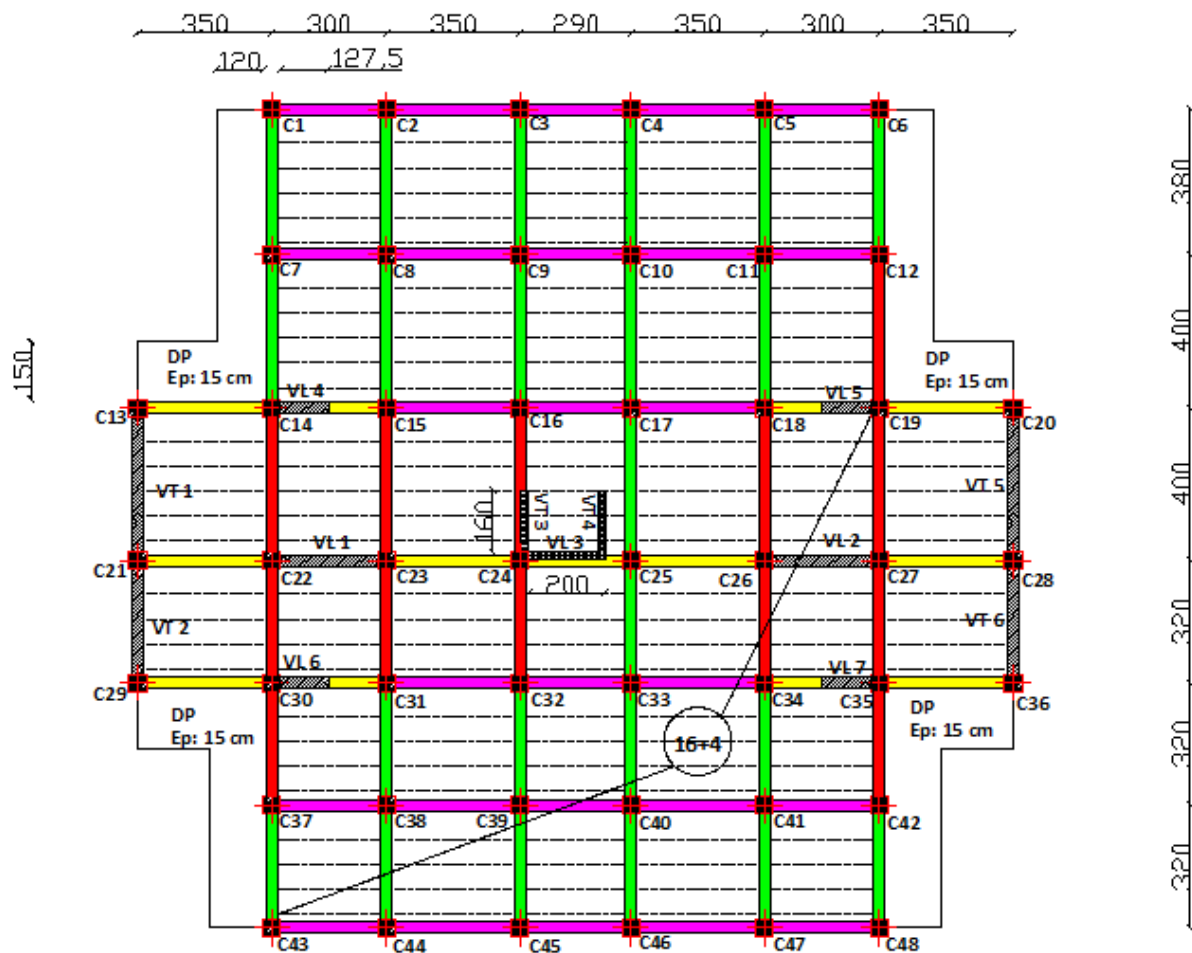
Figure montrant le groupe des poutres pour le ferrailage
